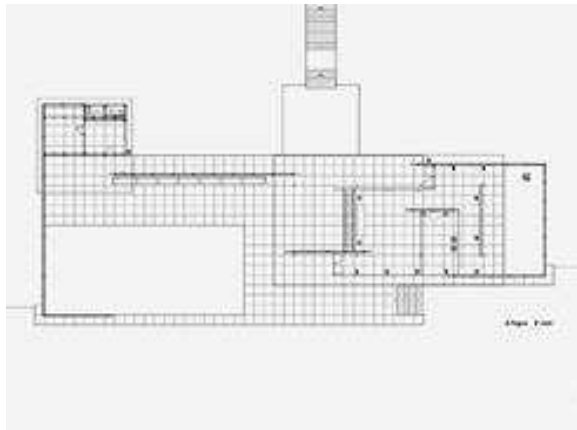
Planta del Pabellón alemán en la Exposición Internacional de Barcelona.
